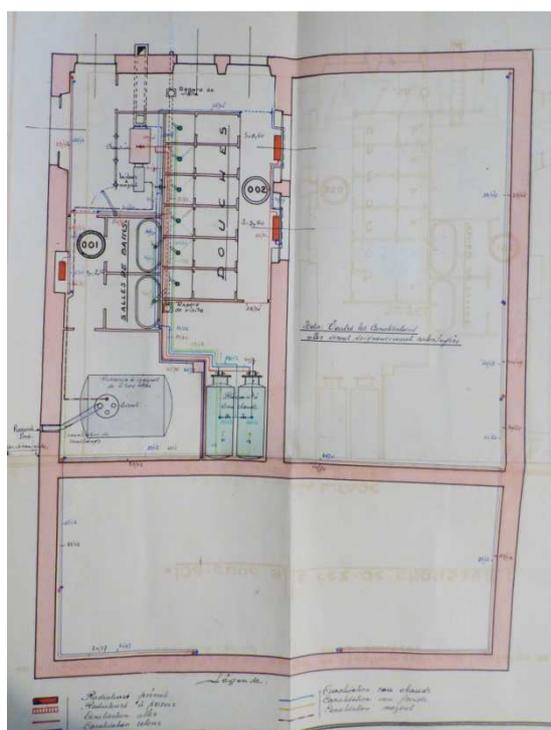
Installation de chauffage central et de bains-douches dans l'école, Maison L. Fage.
